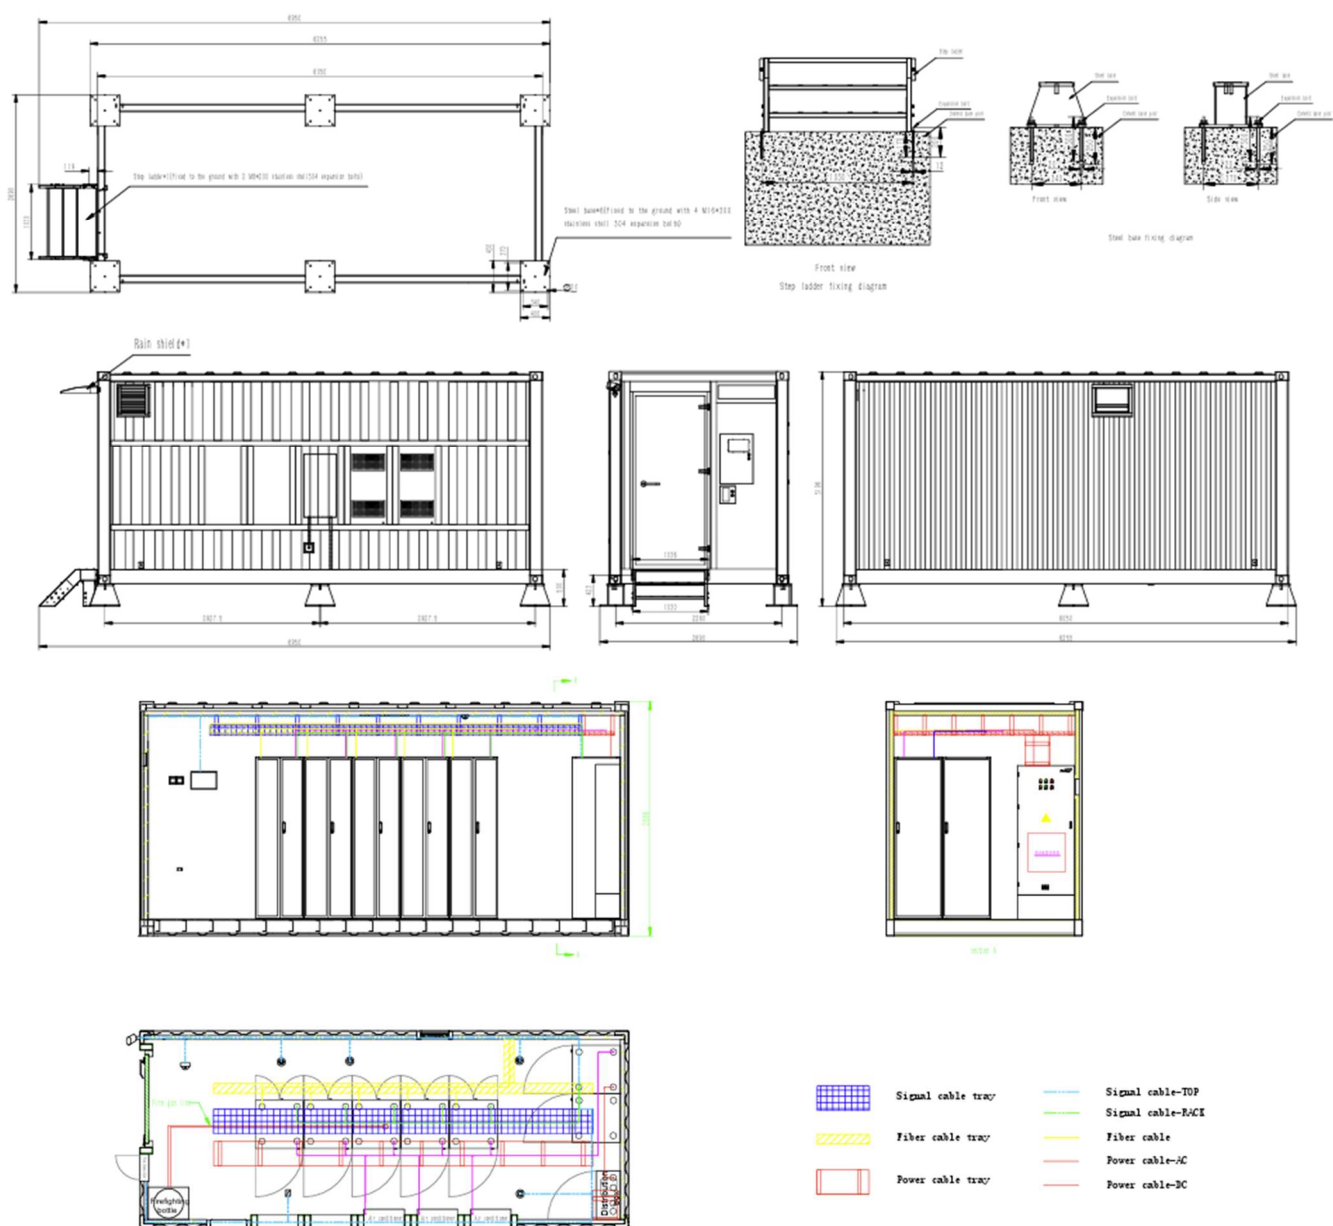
Layout estrutural Centro Móvel de Alta Disponibilidade – CMAD – Fiber Home
